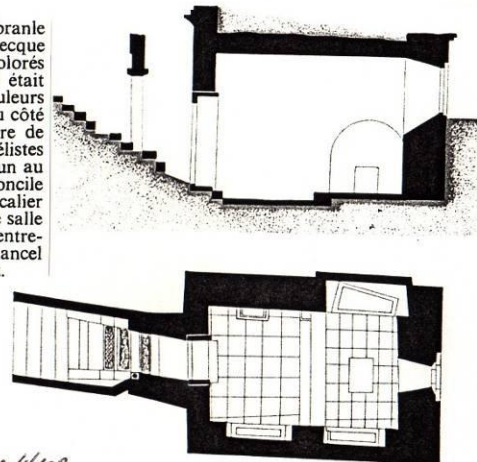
/102. POITIERS. HYPOGÉE DES DUNES : COUPE ET PLAN.
